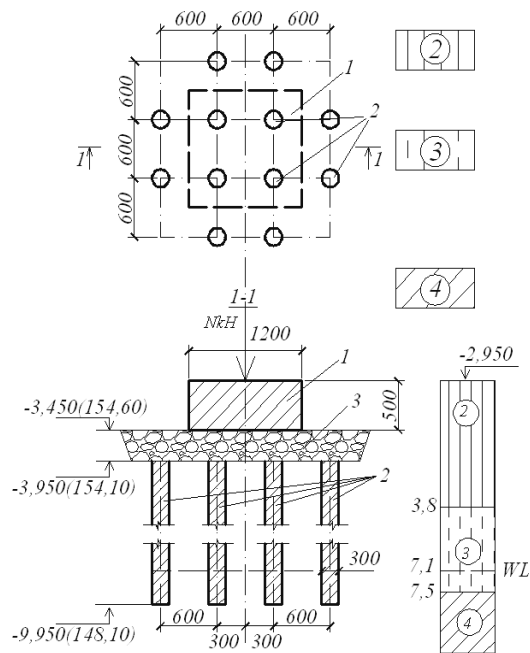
Схема випробувань основи, яка армована вертикальними ґрунтоцементними елементами, залізобетонним квадратним штампом
